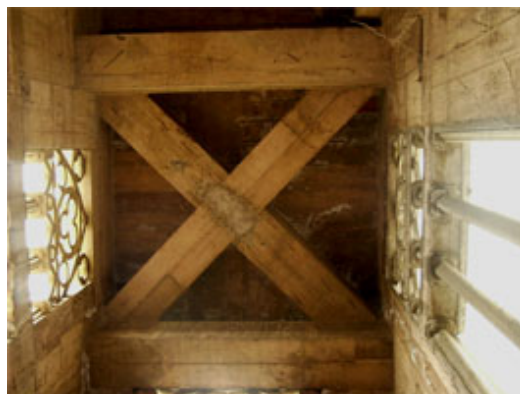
Cruces de vigas de arriostramiento y elementos prefabricados en cerramiento.
